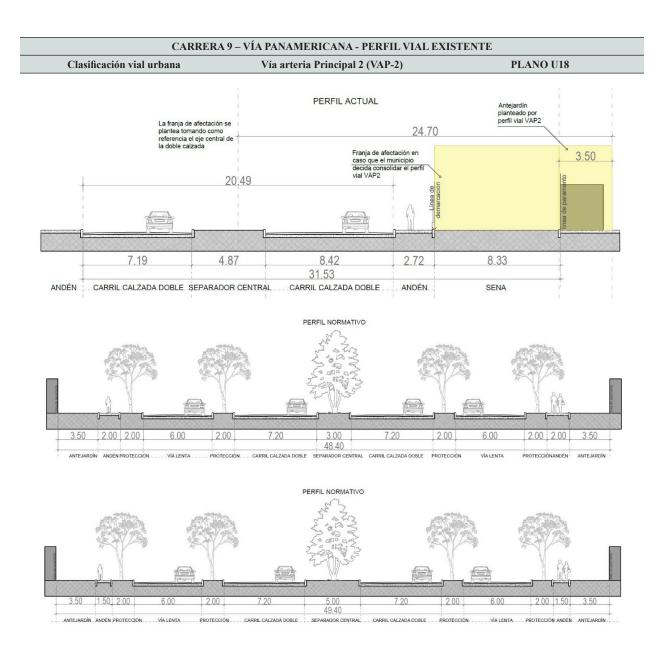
Plano vial – Perfiles viales Carrera 9 y Calle 74N. Fuente: Elaboración propia con base a levantamiento topográfico UD.
